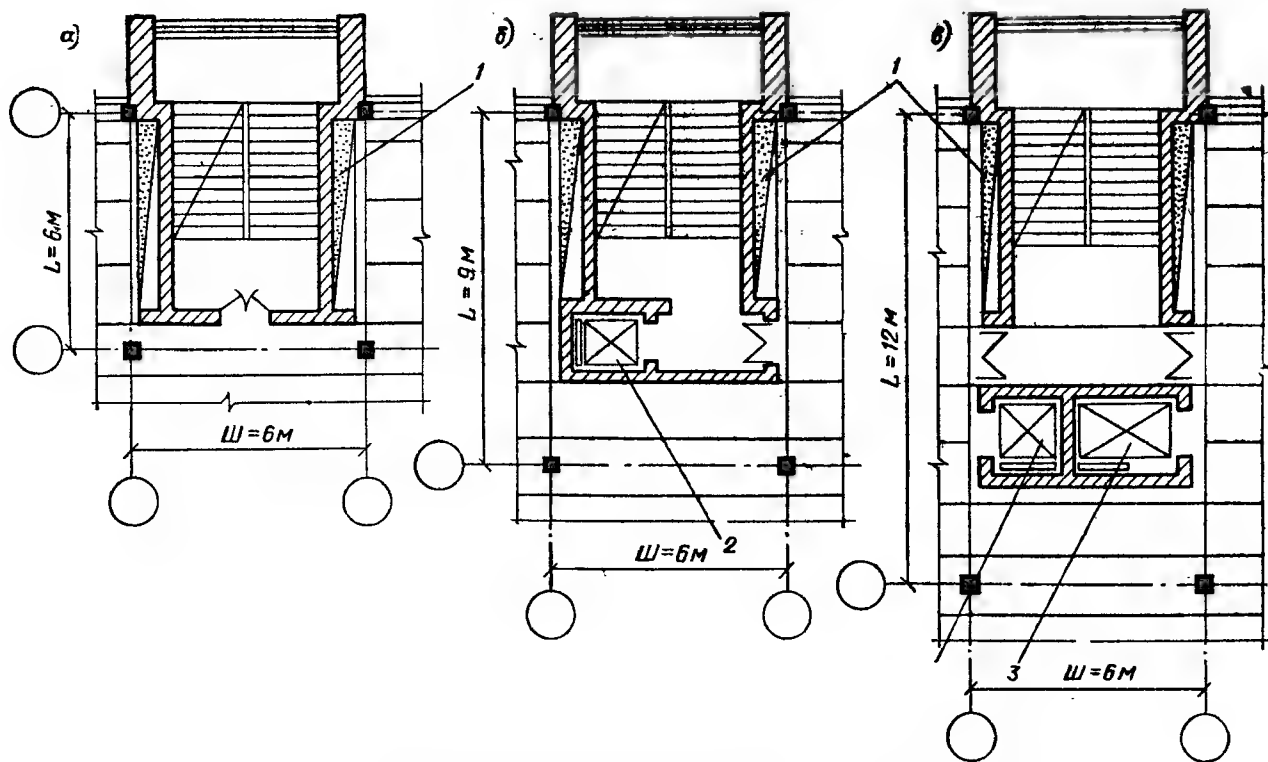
Планы лестниц для зданий с различной сеткой колонн
